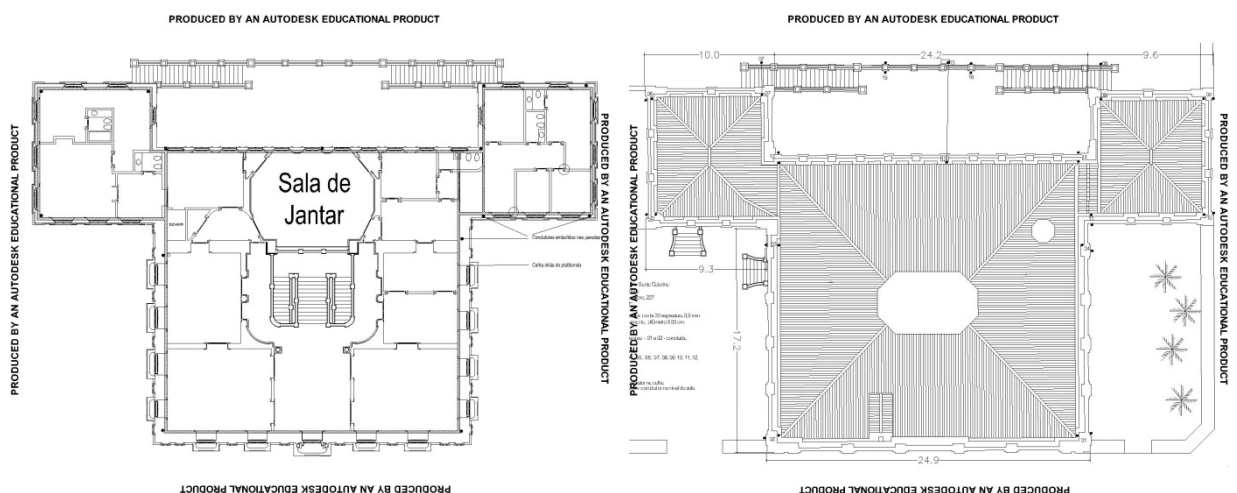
Localização da Sala de Jantar no edifício. A Imagem da esquerda é a planta do 1º piso e a da direita a planta da cobertura.
